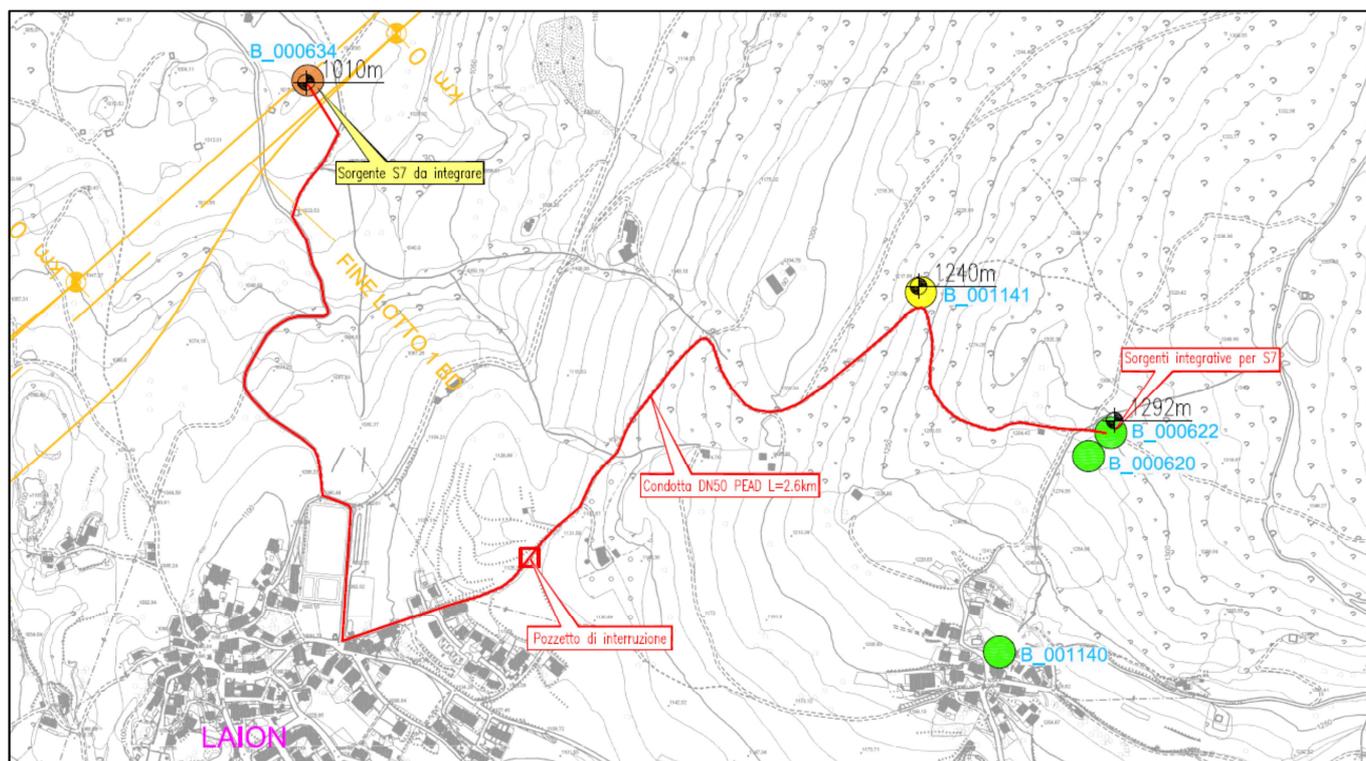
Stralcio planimetrico della soluzione progettuale proposta (fonte: Progetto Definitivo 2013).
